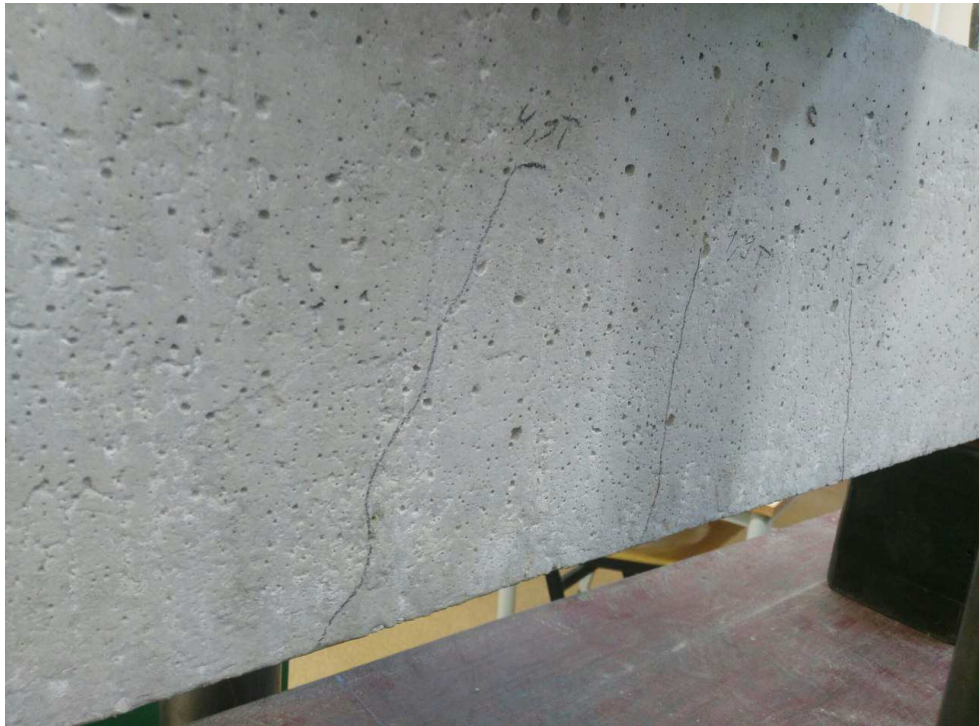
Нормальные трещины в железобетонной балке при испытании
